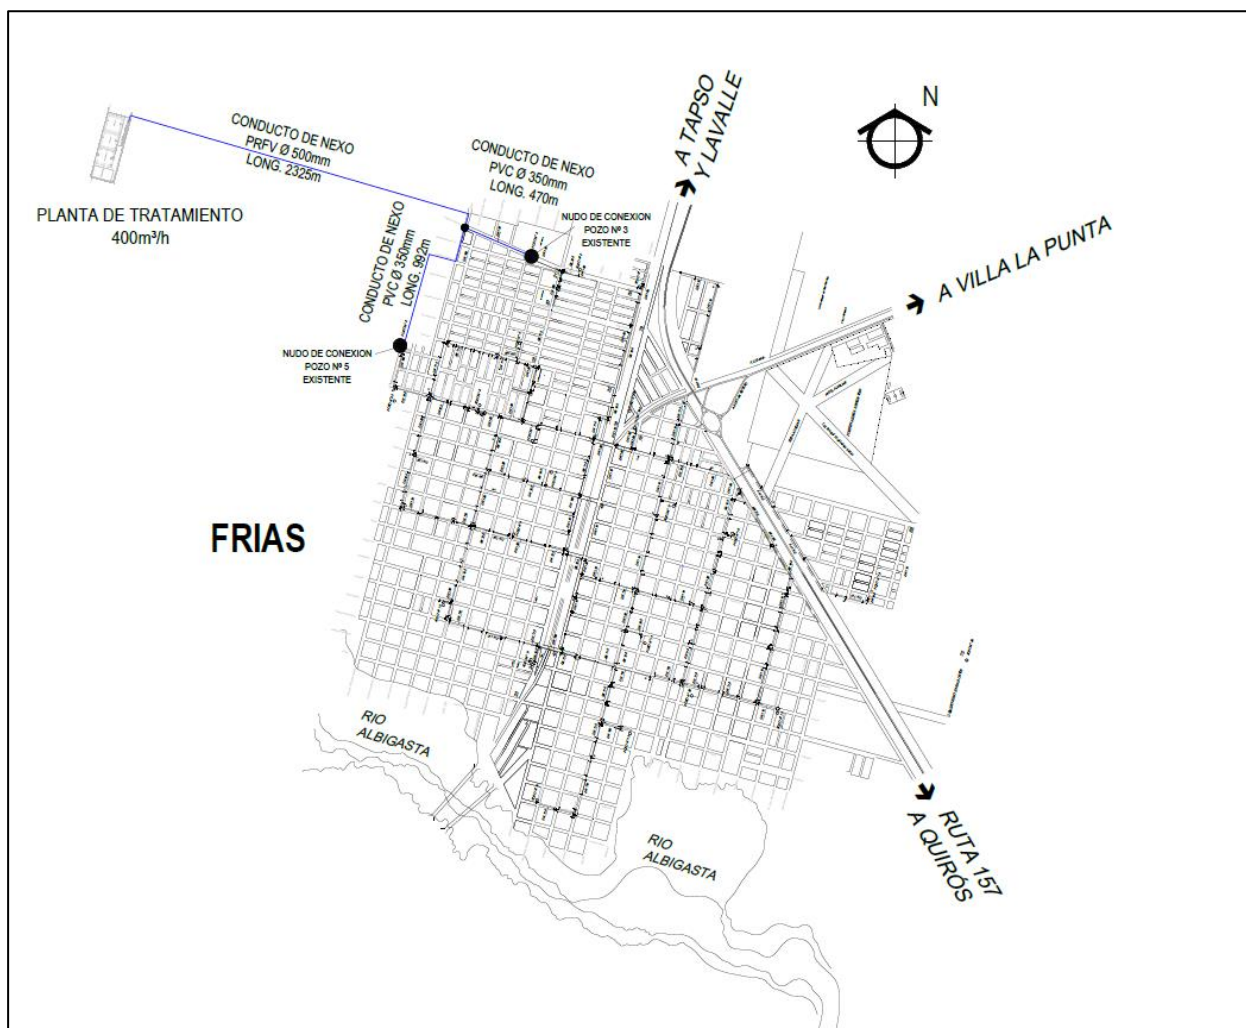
Nexo de Planta de Tratamiento con la red existente en Frías
